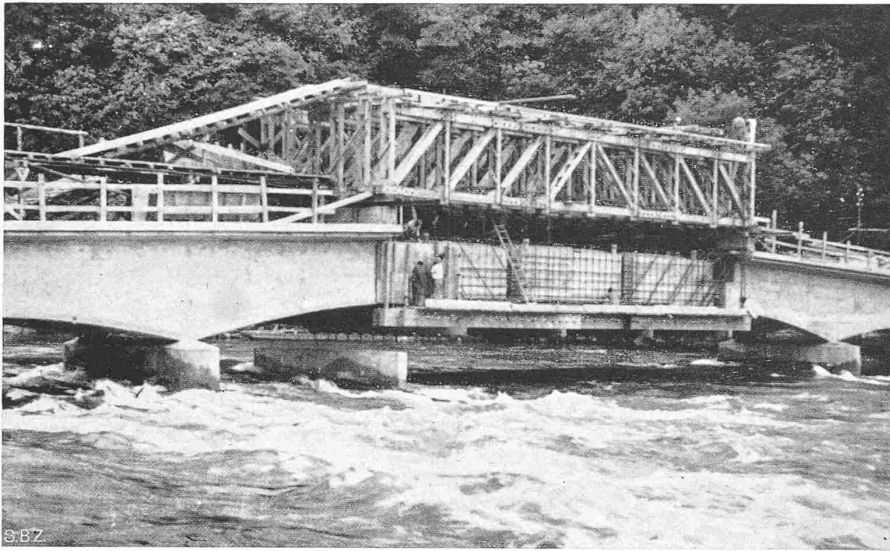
Lehrgerüst-Fachwerkträger über der Mittelöffnung
